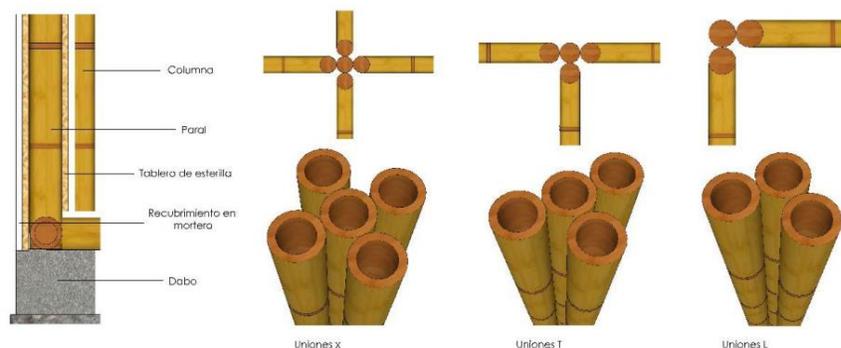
Uniones entre columnas para la estructura del prototipo. Fuente: (Herrera, 2019).
